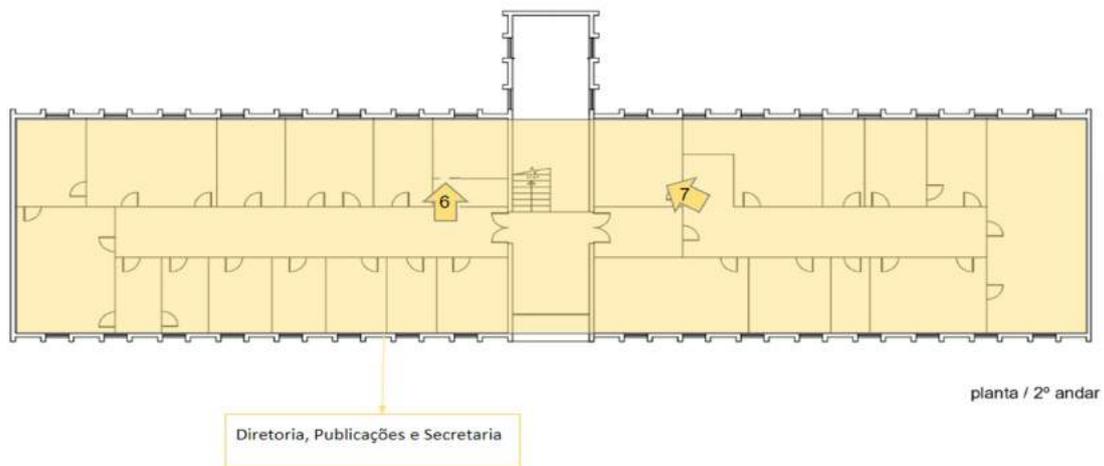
Planta do SAE – segundo pavimento – Montagem Autor: Dutra, P. 2020
